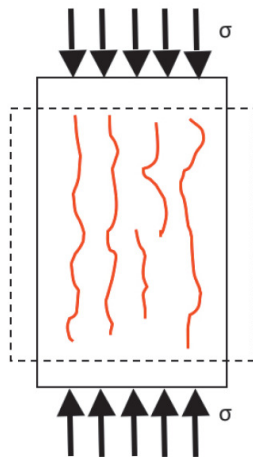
Fissuração em corpo de prova sob compressão axial
